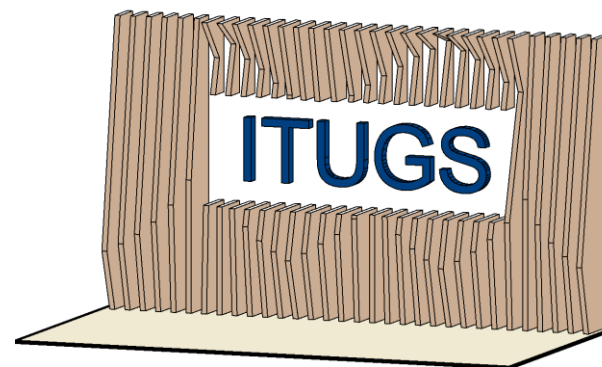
Detalle 2 Muro ingreso . Fuente: Elaboración propia.
